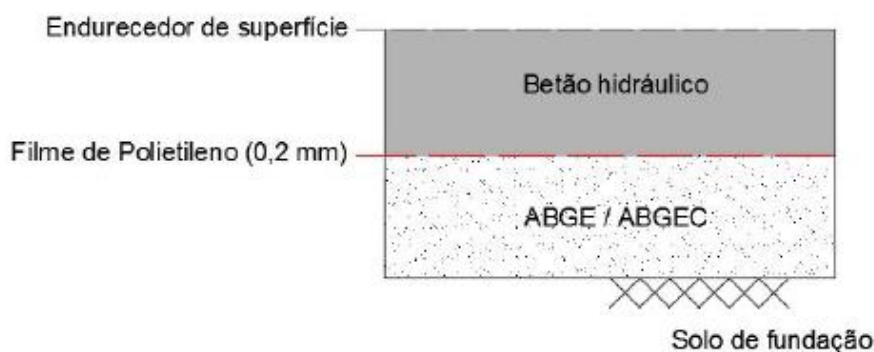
Camadas constituintes de um pavimento rígido [10].
